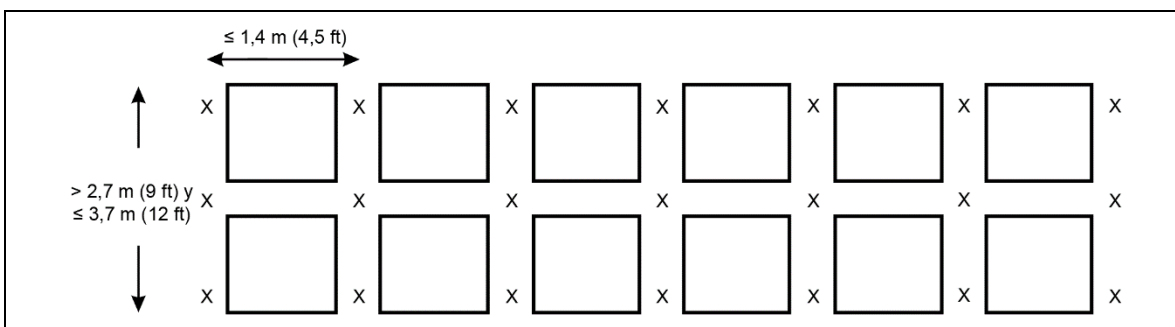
Vista en planta de una configuración alternativa de rociadores intermedios para estanterías dobles con una anchura máxima de 3,7 m (12 ft)
